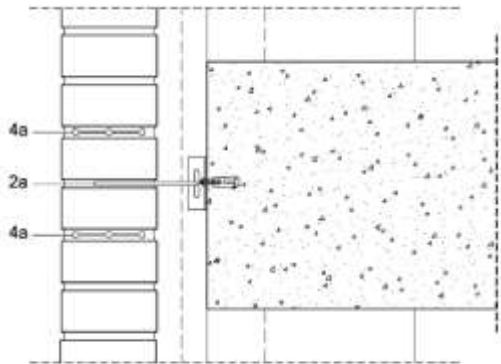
Sección vertical. Detalle de fijación de anclaje GEOANC® a forjado o pilar.
